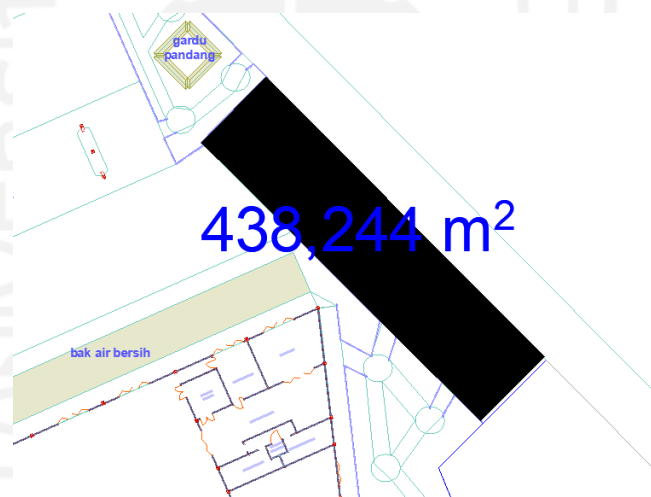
Gambar luasan bangunan pabrik SWRO
